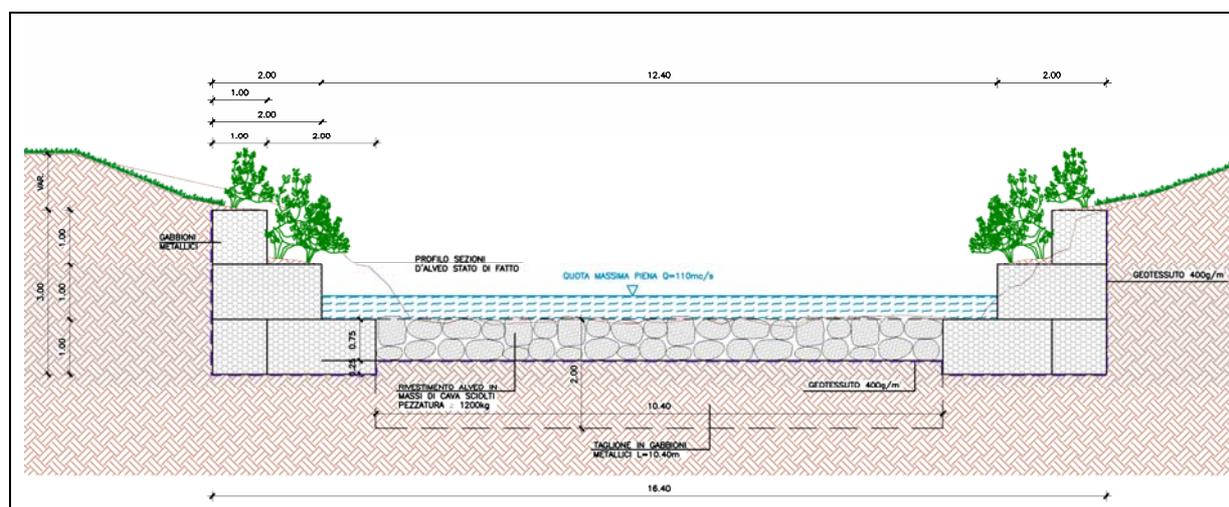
Sistemazione Torrente Guardia alla foce – stato di progetto
